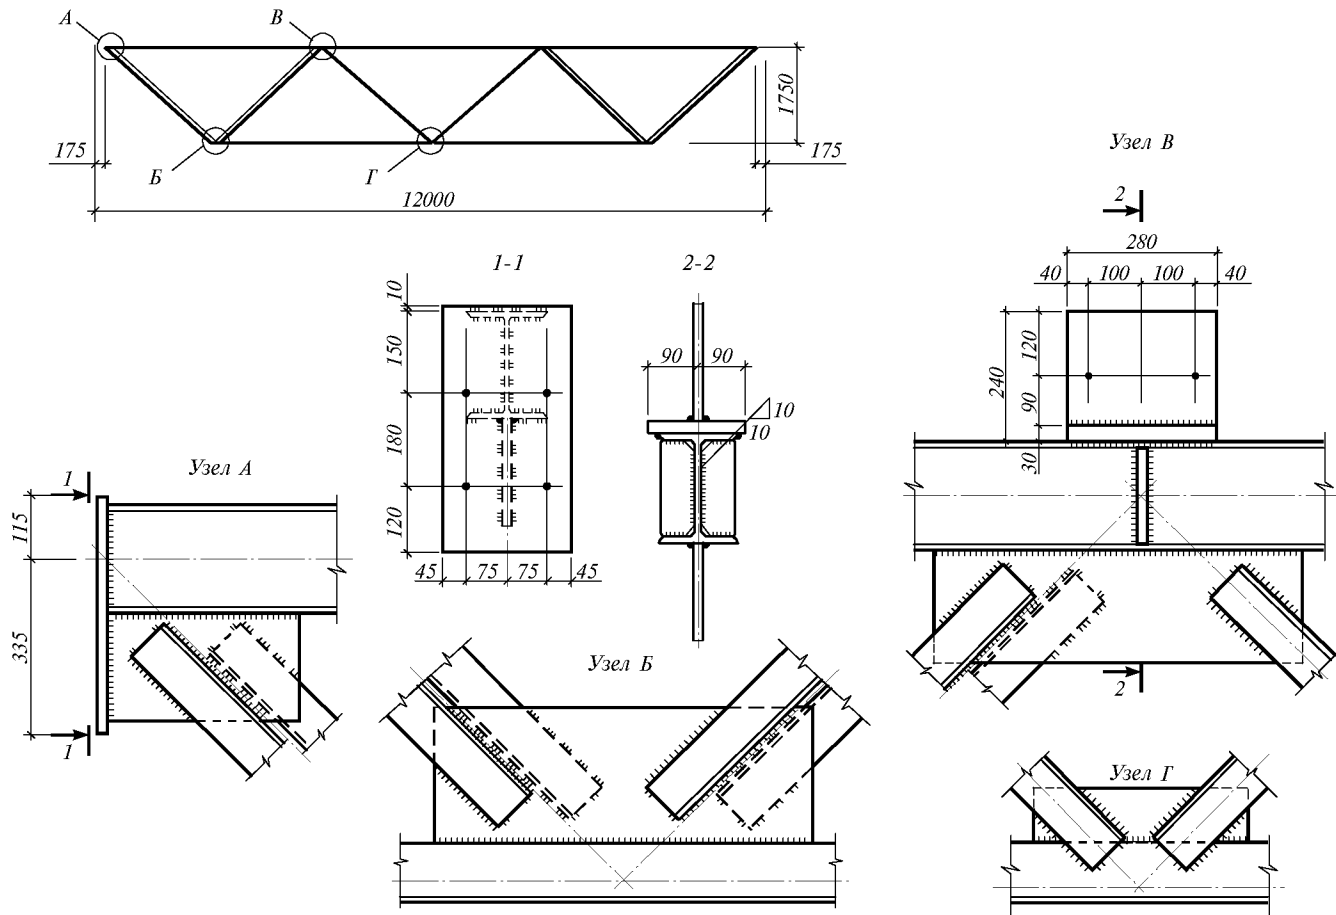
Подстропильная ферма из прокатных профилей типа «Житомир» пролетом 12 м
